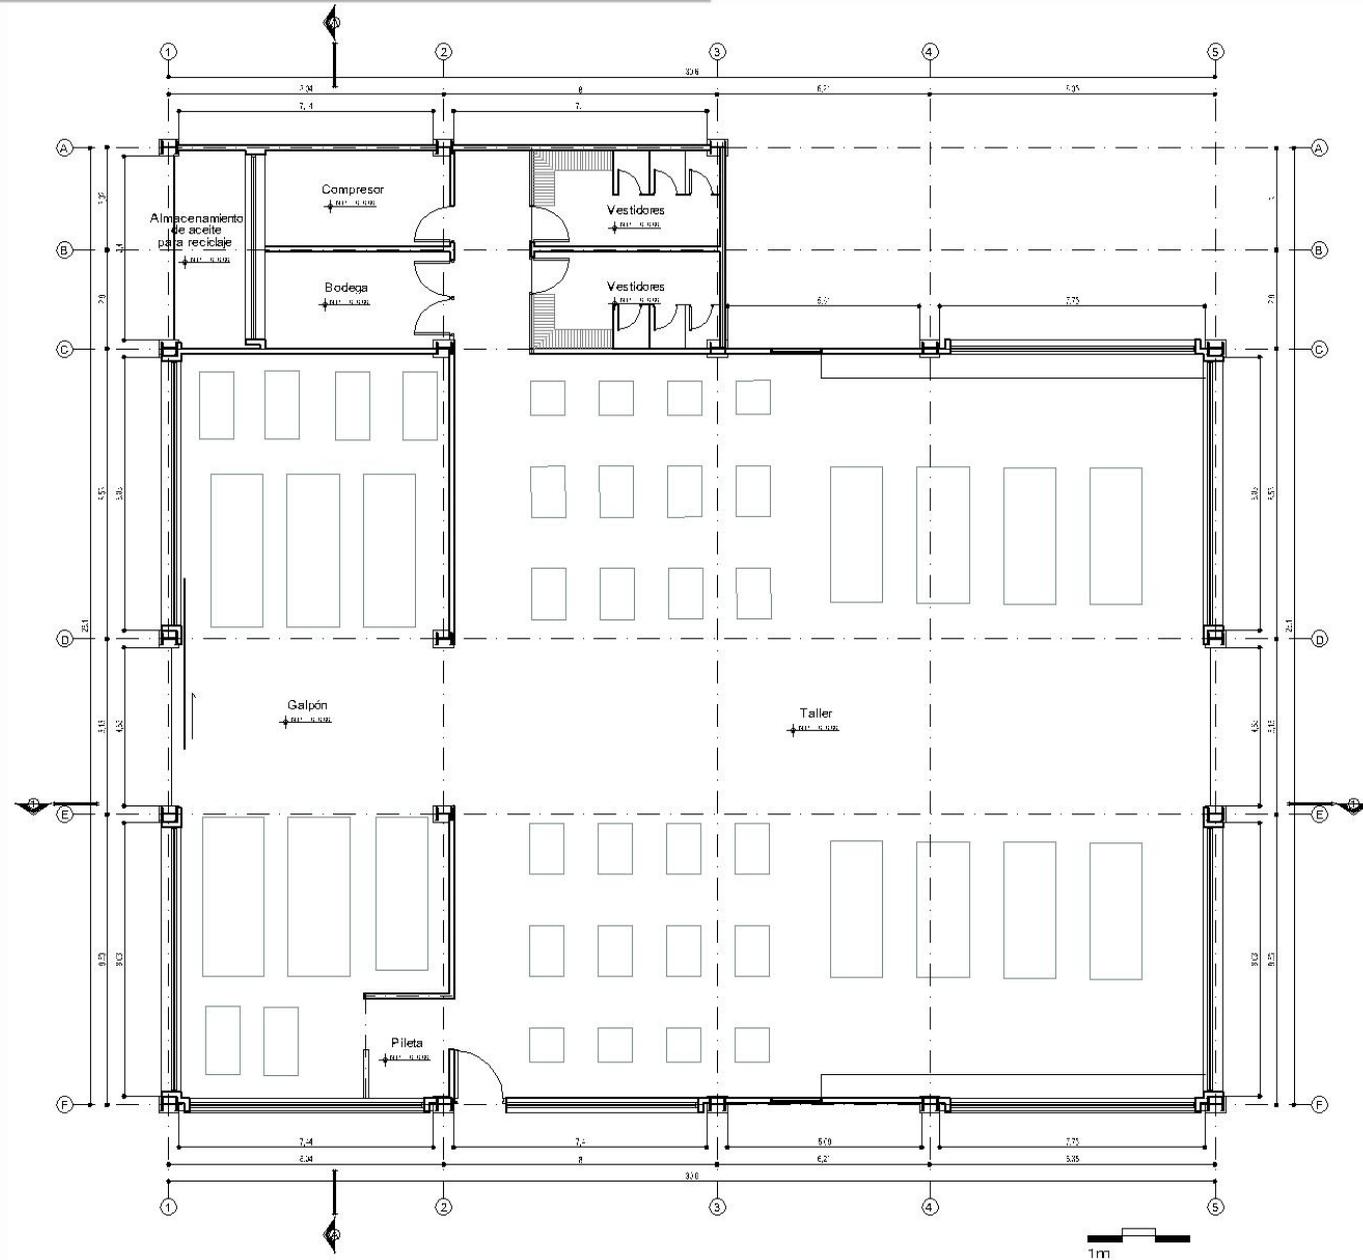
Planta de Distribución arquitectónica. PRIMER NIVEL
